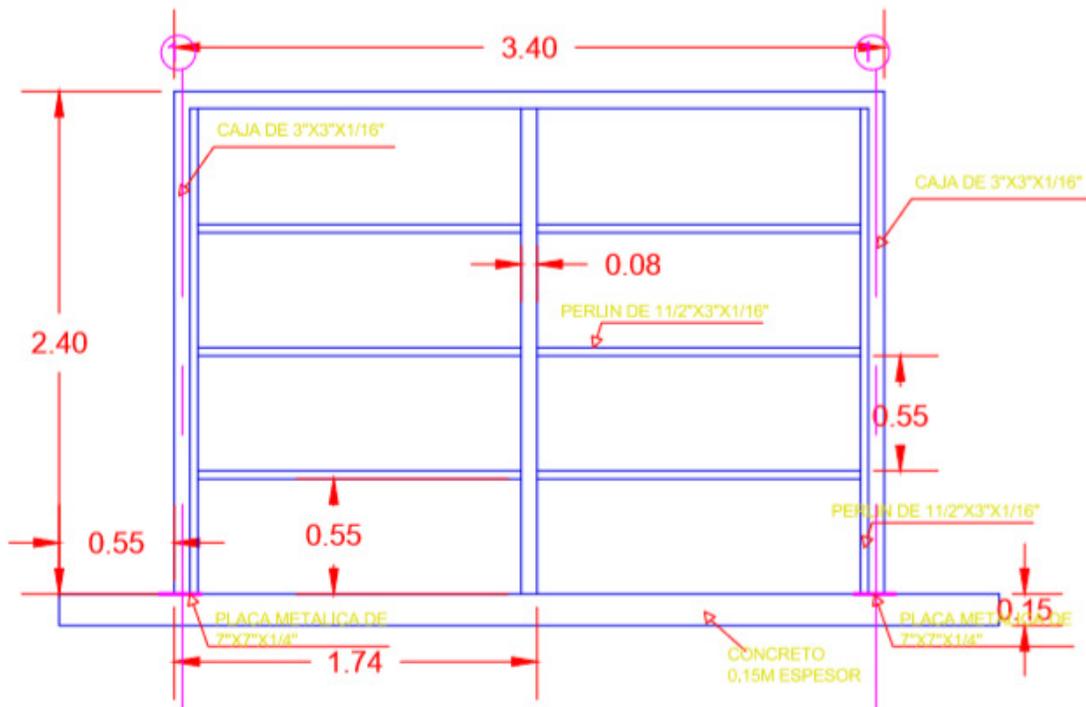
Elevación estructural vista frontal, Fuente: PIMA.
